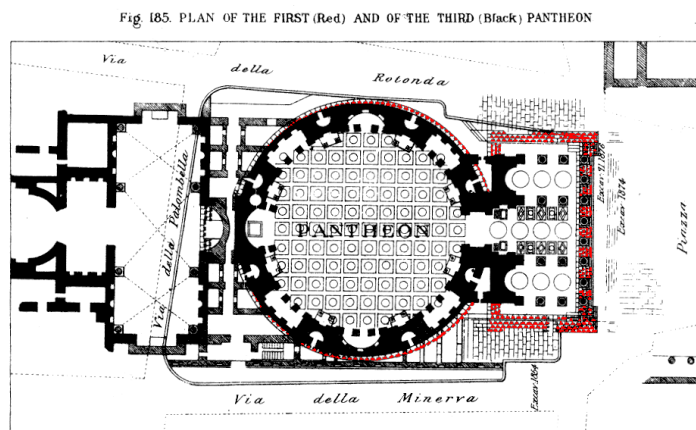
Planta do primeiro (vermelho) e do terceiro (preto) Panteão
